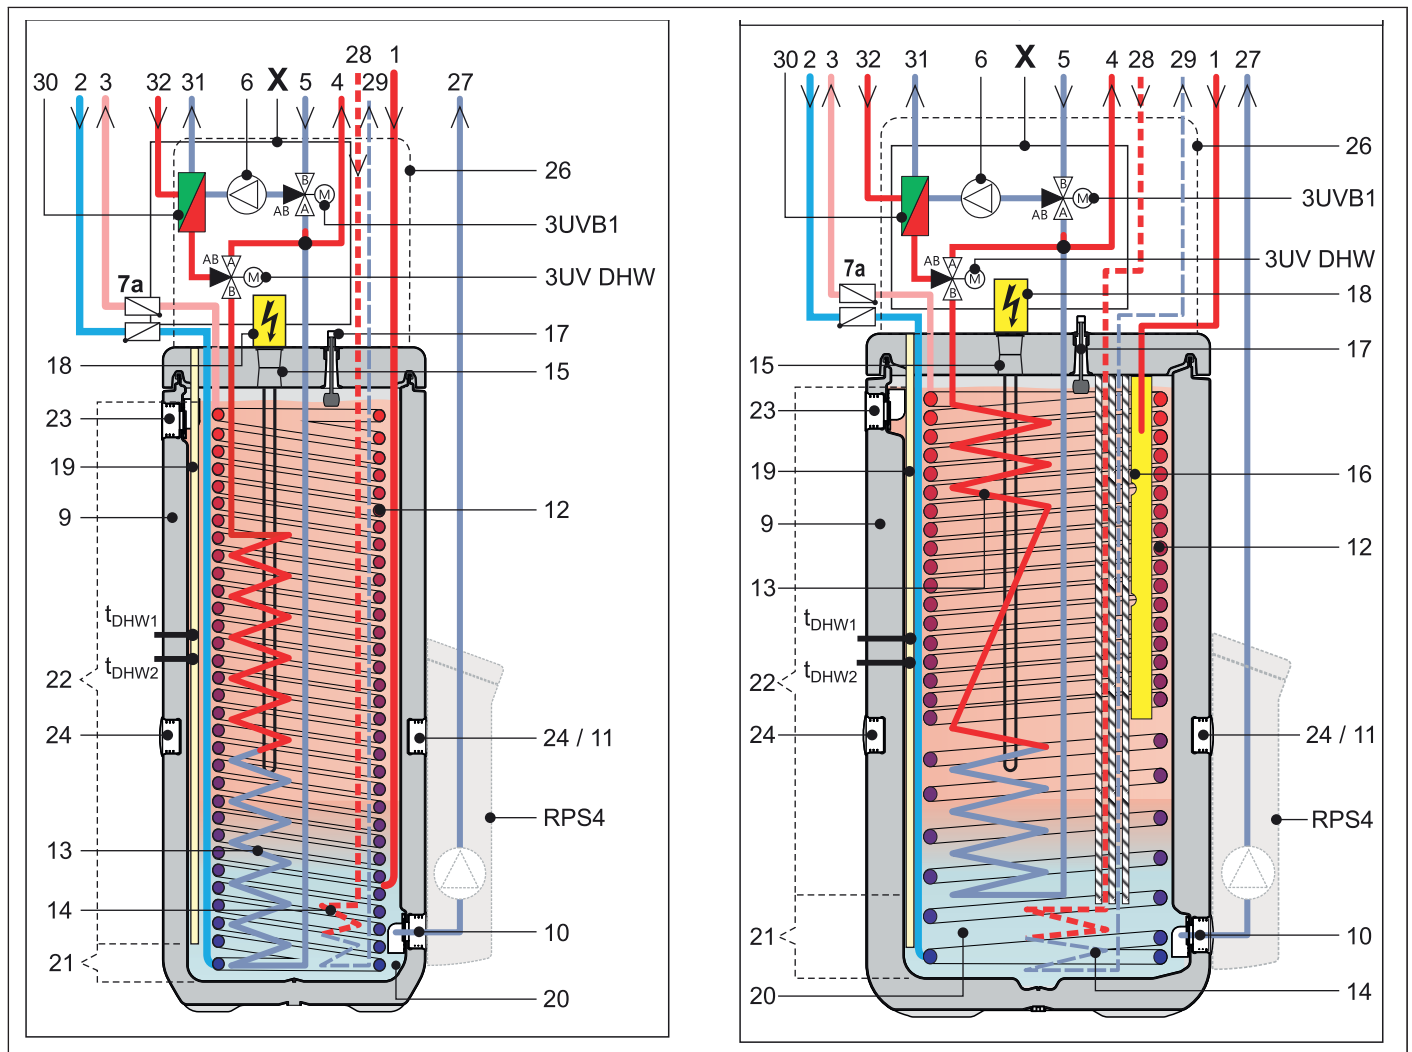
Hydraulischer Aufbau - Innengeräte - HPSU compact Ultra
